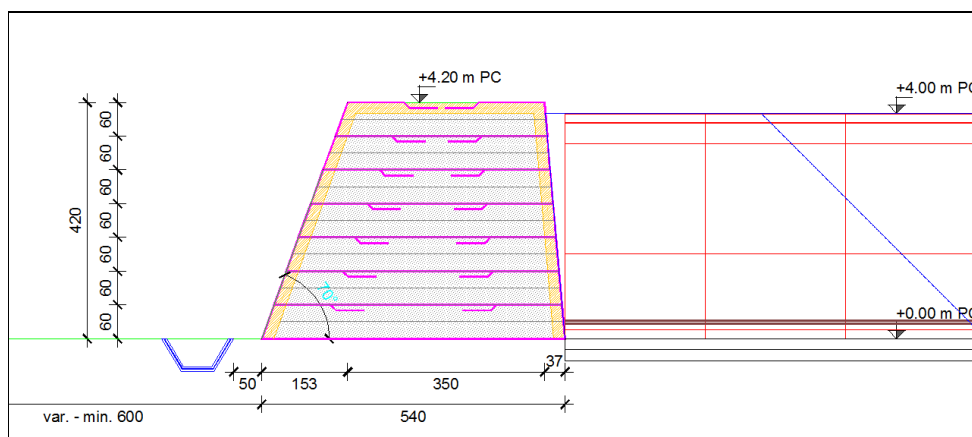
Sezione tipo dello stato di progetto rappresentativa del rilevato perimetrale, delle vasche in cls e della canaletta di scarico prefabbricata.
